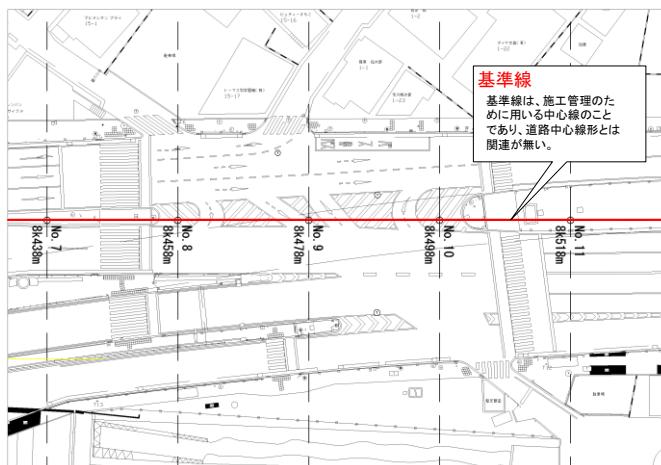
施工者が当該工事の施工管理のために新たに定める道路中心線（基準線）
